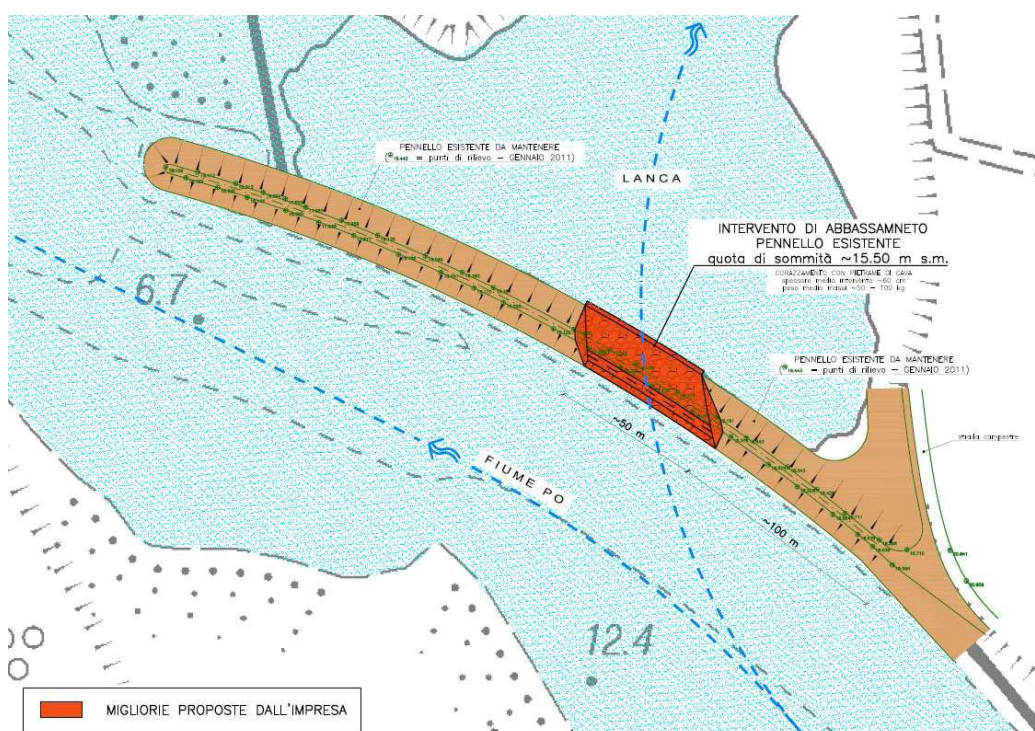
Stralcio planimetrico dell'intervento di abbassamento del pennello di curva 14
